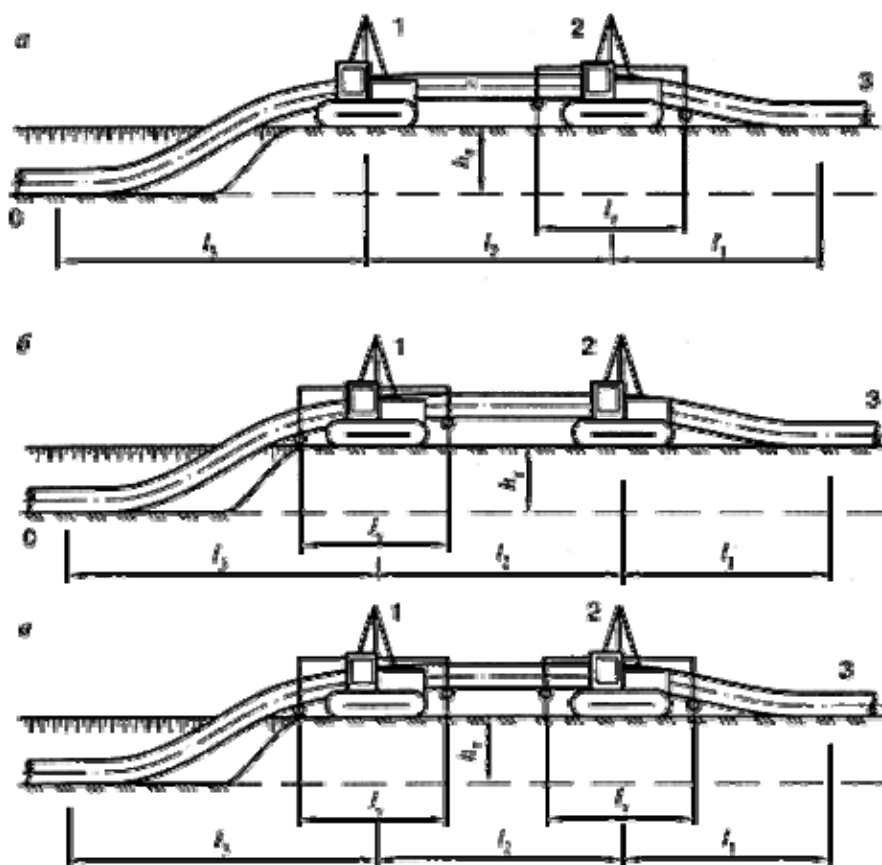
Схемы непрерывной укладки полиэтиленовых трубопроводов с бермы траншеи с применением траверс на трубоукладчиках
